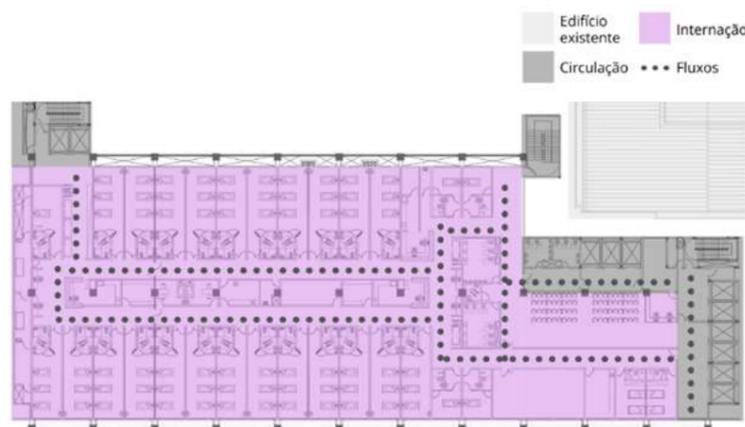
Setorização do projeto de ampliação – 5º pavimento
